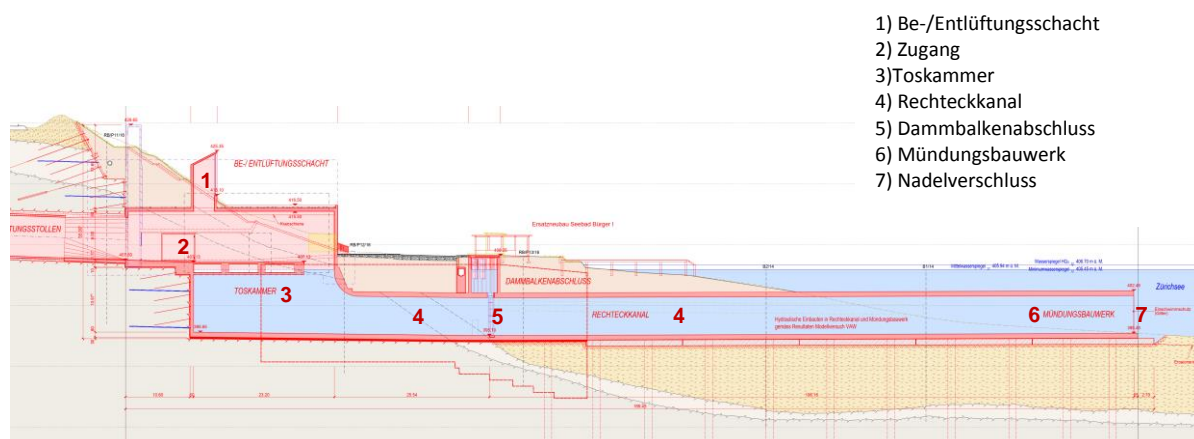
Längsschnitt durch das Auslaufbauwerk
